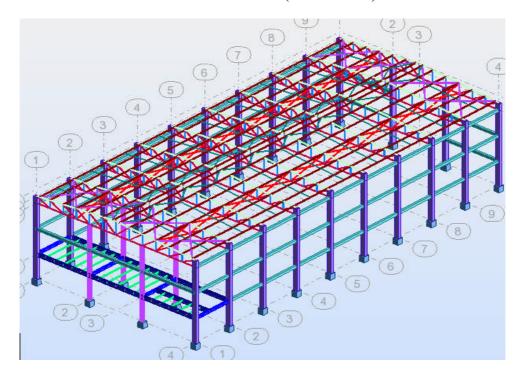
Vue des ciseaux de stabilités en 3D.
